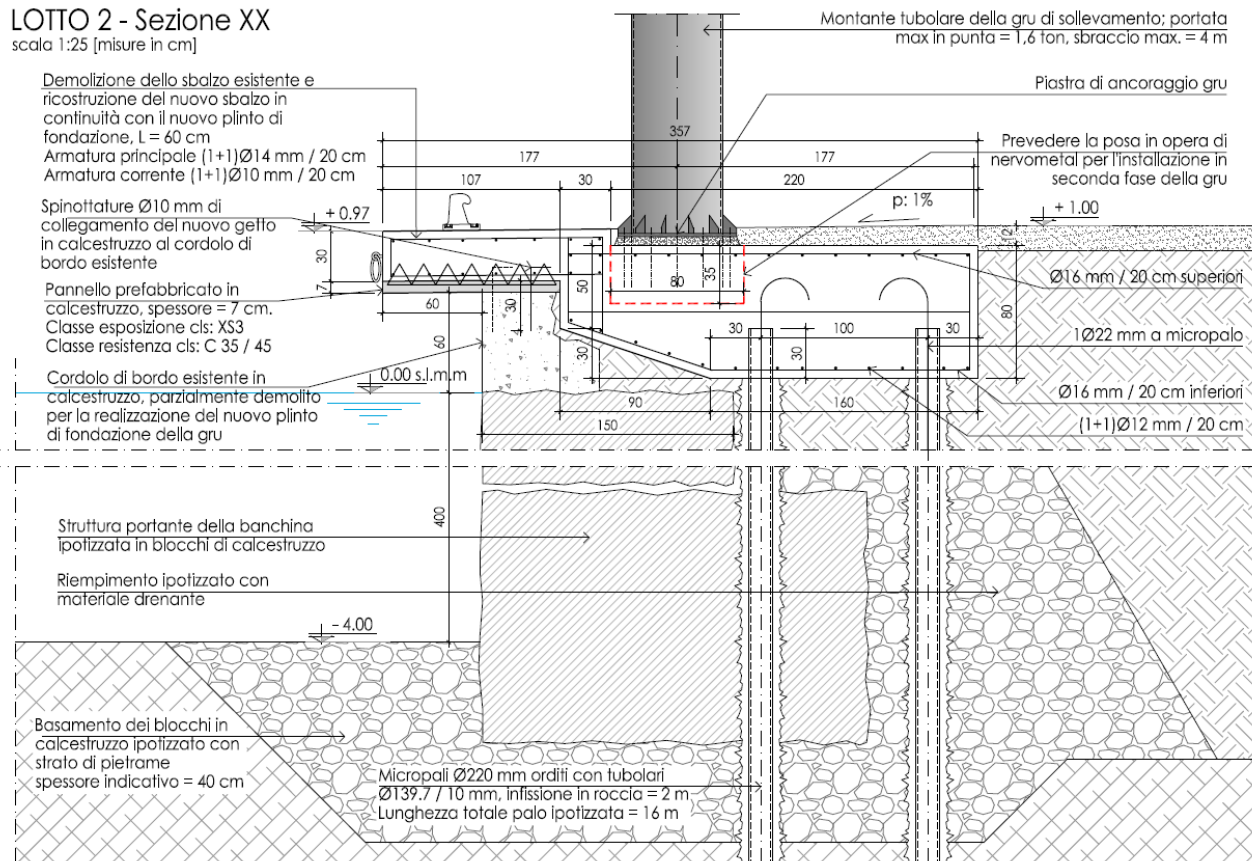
Sezione tipica intervento banchina sud – zona gru
